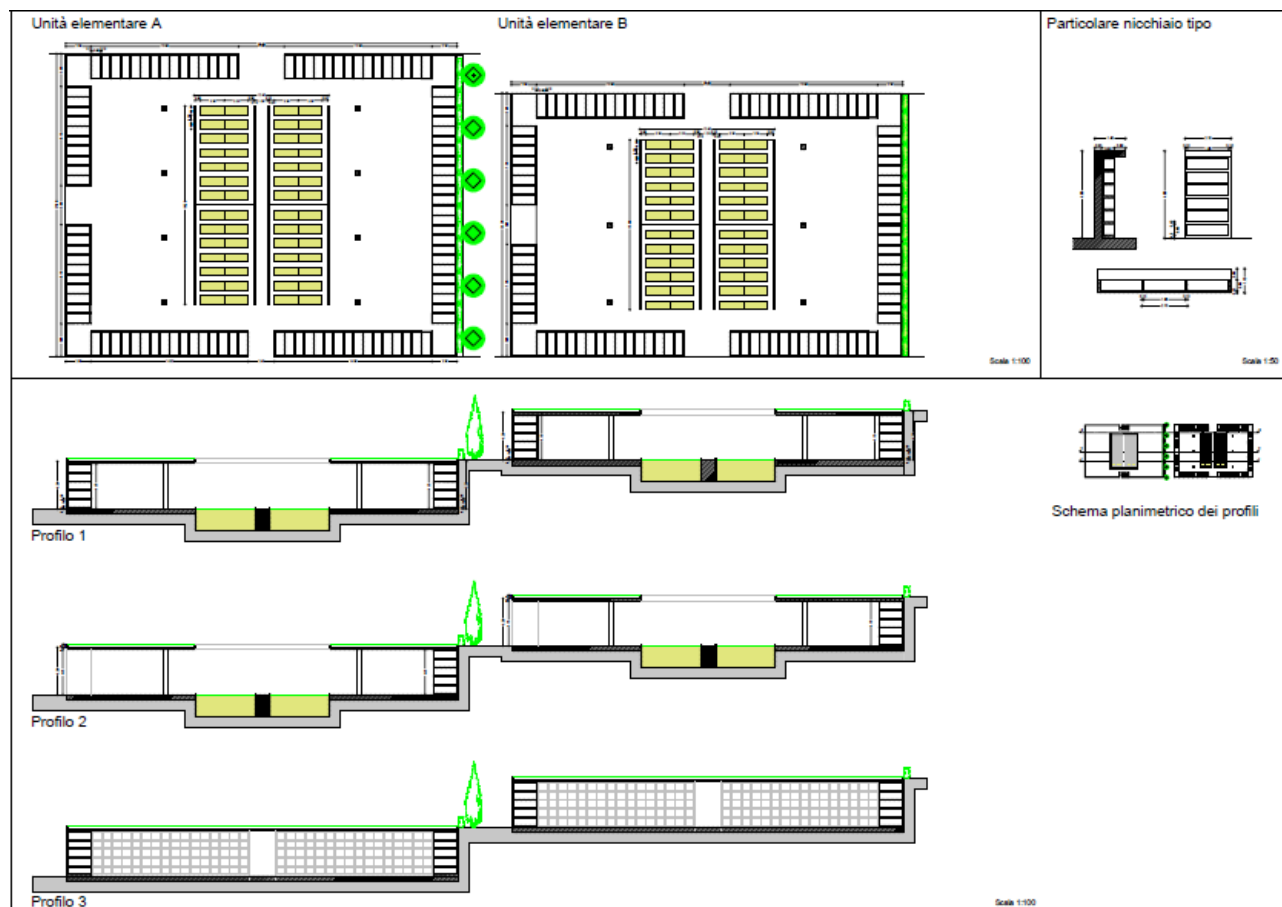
Progetto Preliminare - Pianta coperture Area ex vivaio - Elaborato PR_AR_003.02
